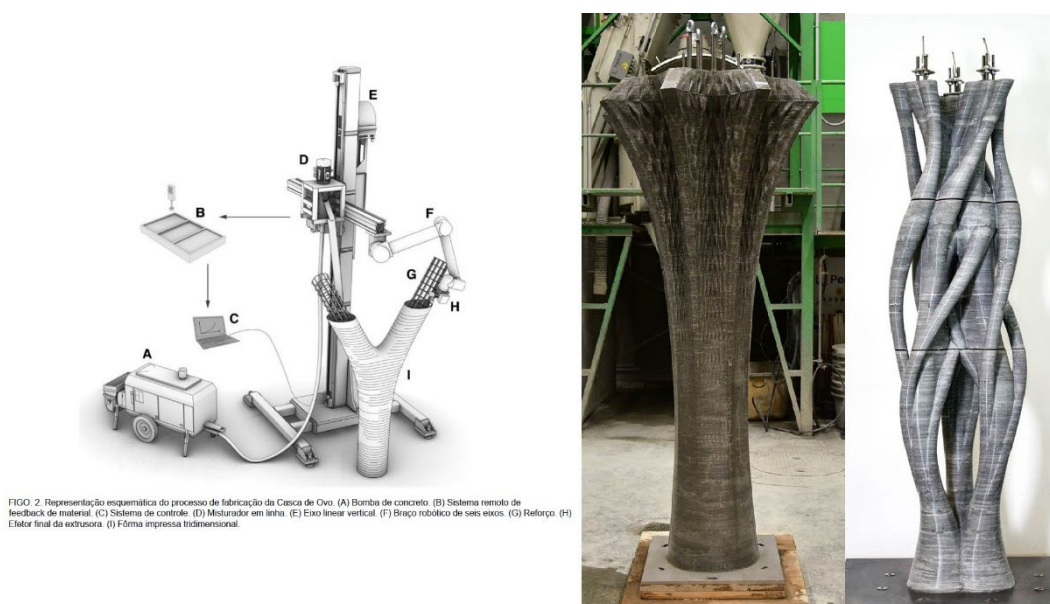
Estruturas de concreto construídas com fôrmas Eggshel
